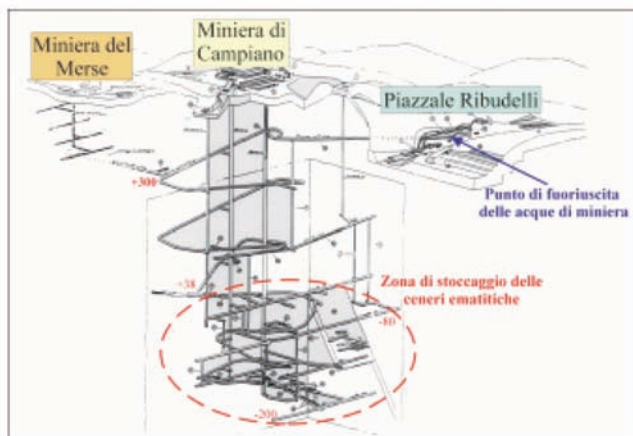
Aspetto attuale delle gallerie nell'area mineraria di Boccheggiano-Campiano.
